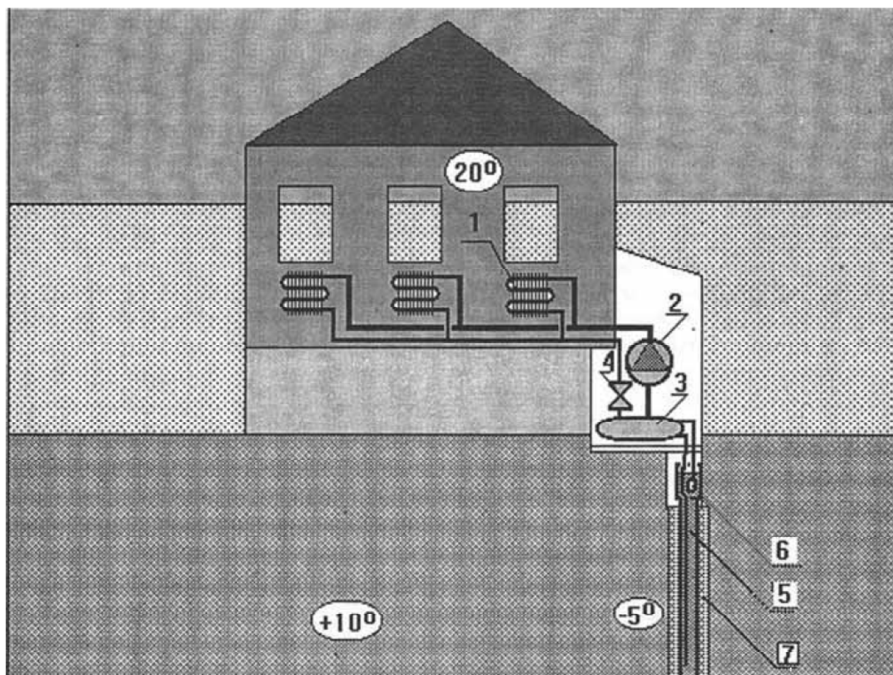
Схема теплового насоса, що використовує теплову енергію ґрунту в системі опалювання
